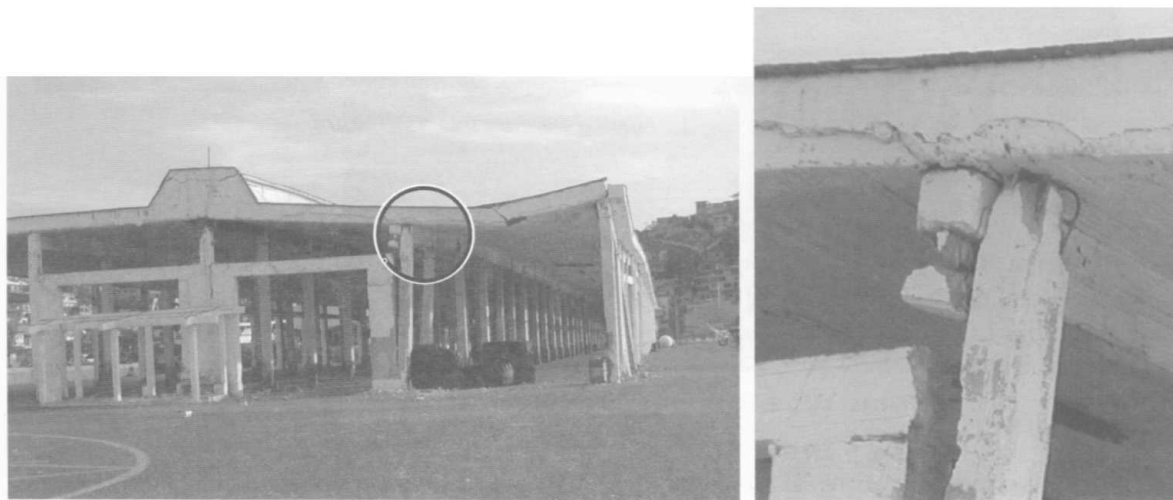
Vista desde el extremo del muelle, falla de la conexión viga-columna
